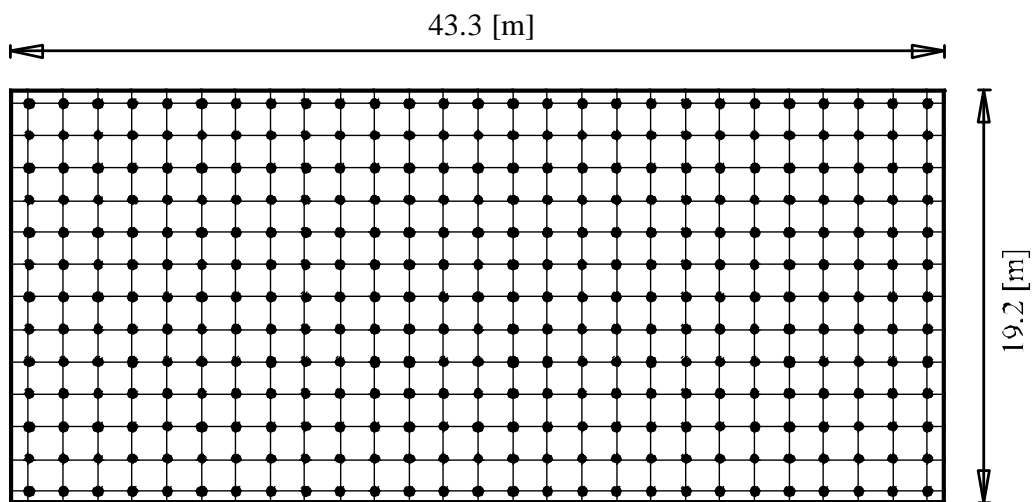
Stonebridge Tower*: Draufsicht der Platte mit Pfählen
